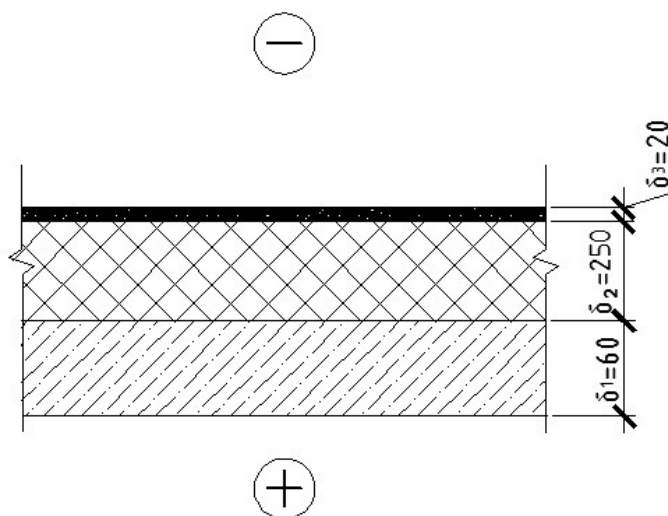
Розрахункова схема суміщеного перекриття
